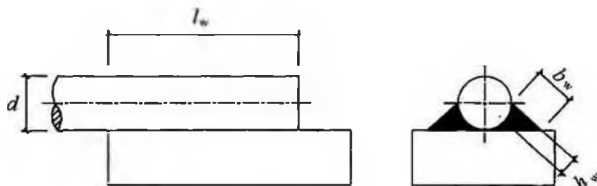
柱纵向钢筋与钢节点竖板连接示意图
